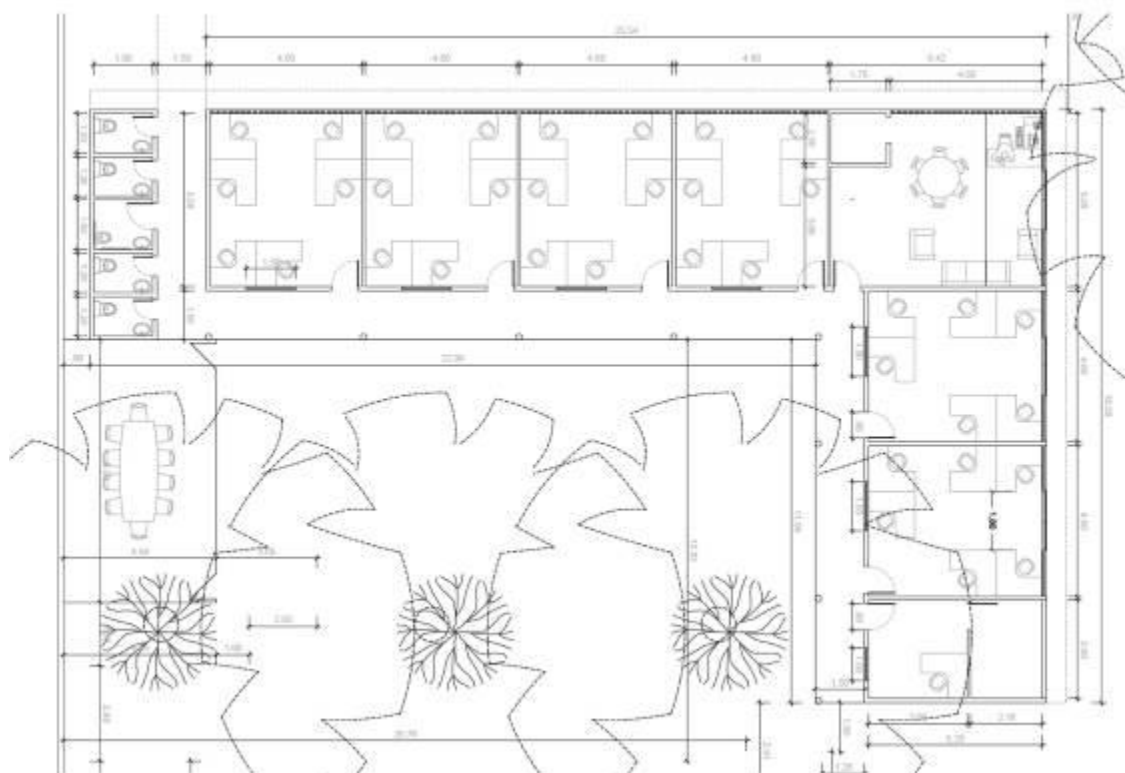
Detalhe da planta-baixa da edificação projetada para abrigar o setor técnico.
